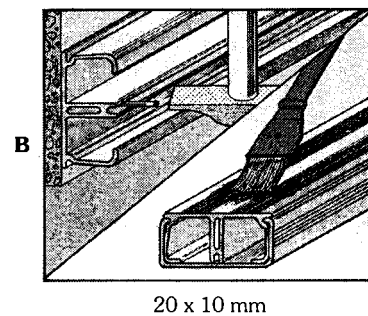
A e B - Corte e fixação de perfis de PVC. Sistema X. Cortesia: Pial-Legrand.
